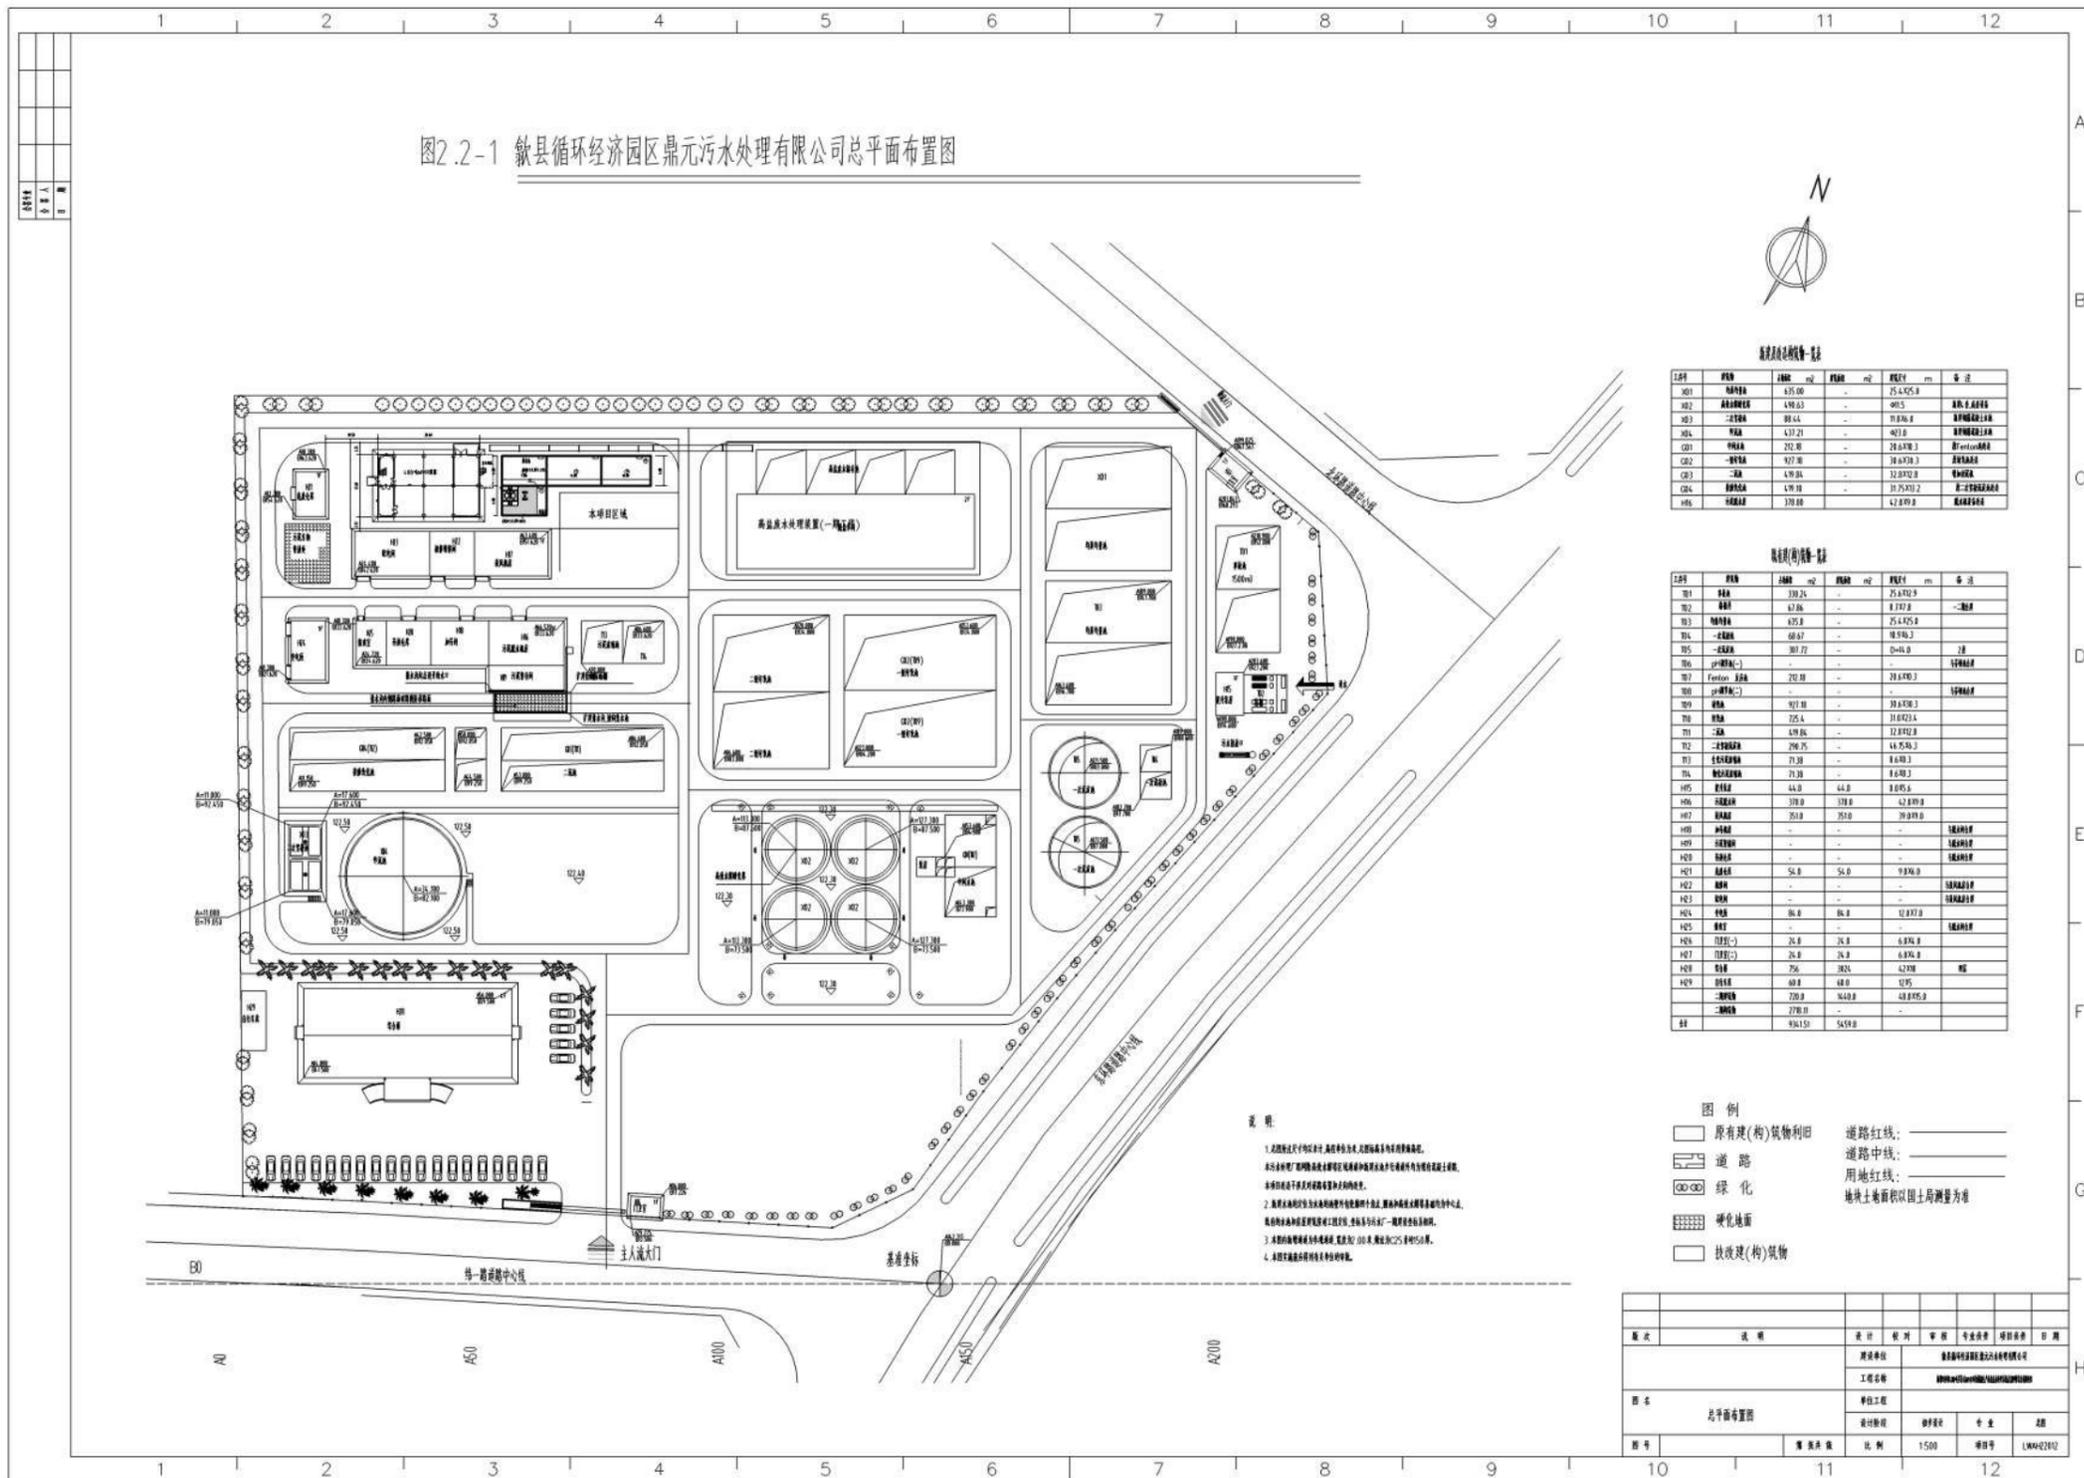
歙县循环经济园区鼎元污水处理有限公司总平面布置图
